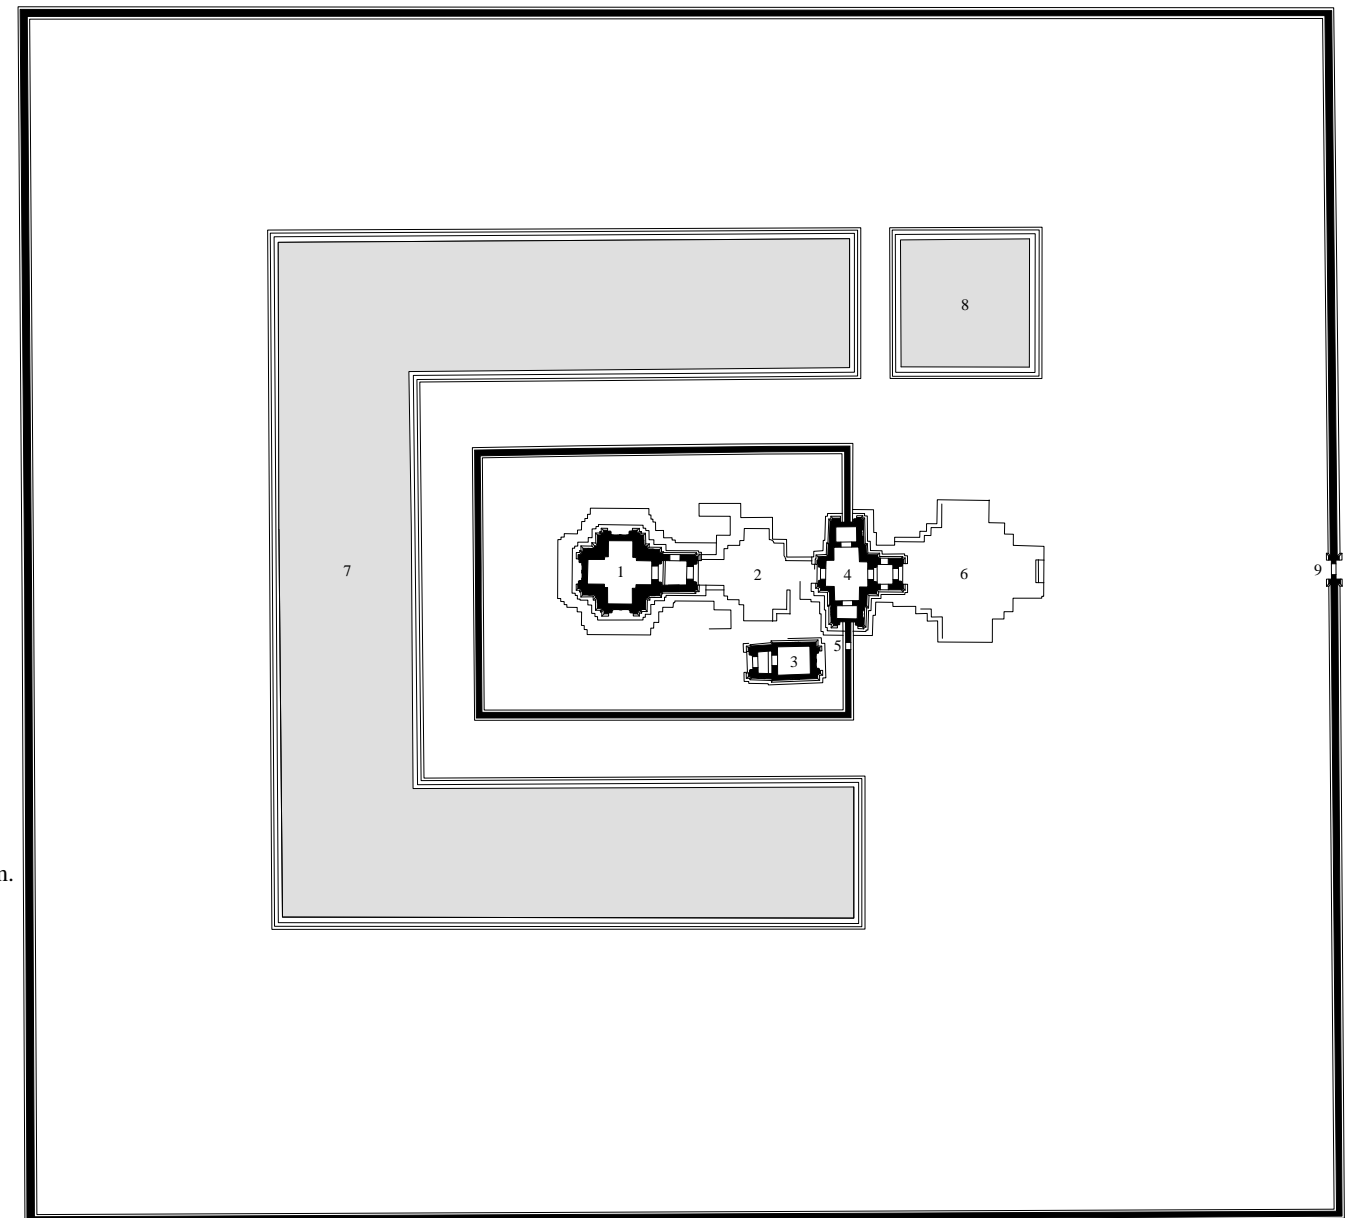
Plan du domaine de Krol Kô
